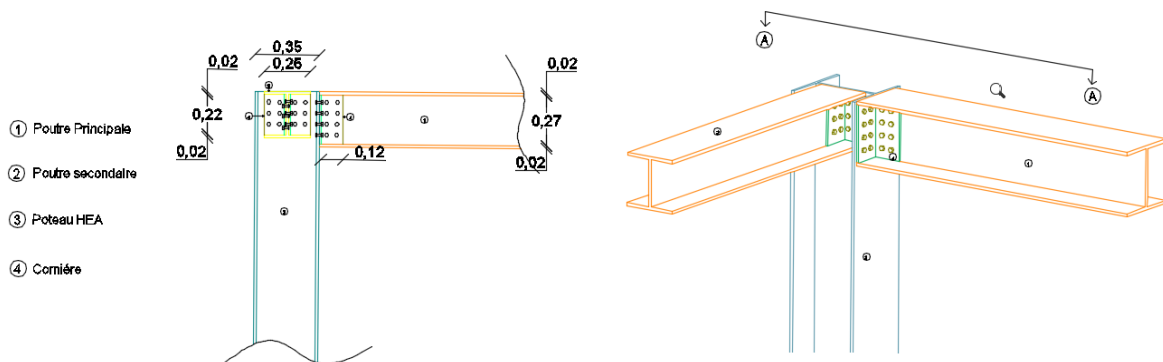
Détail d'assemblage d'un poteau poutre.
